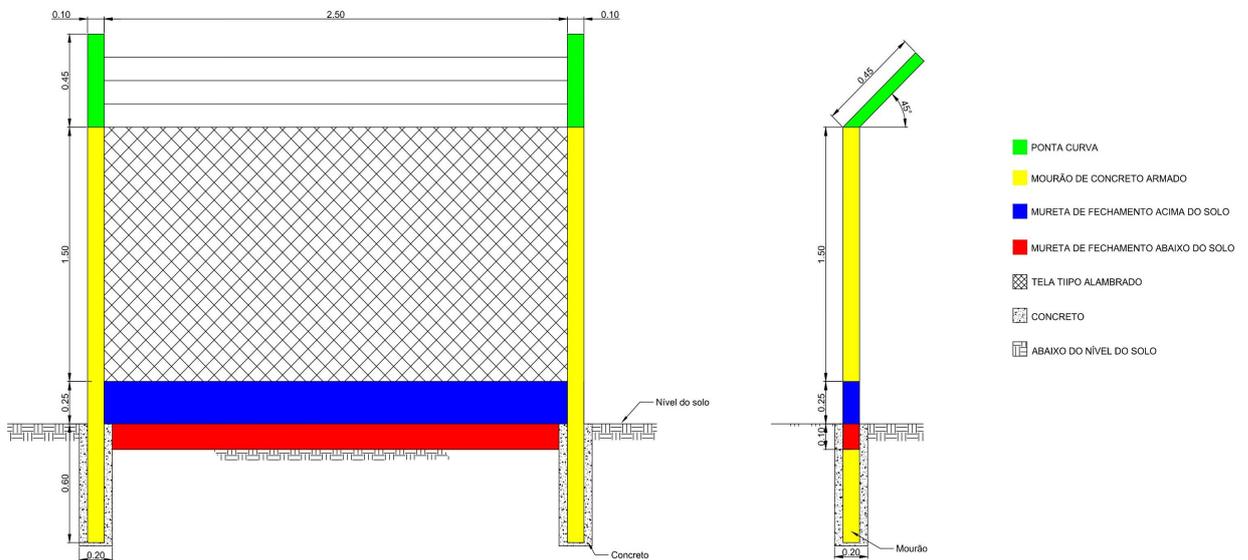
Dimensões para instalação de cerca tipo alambrado.
